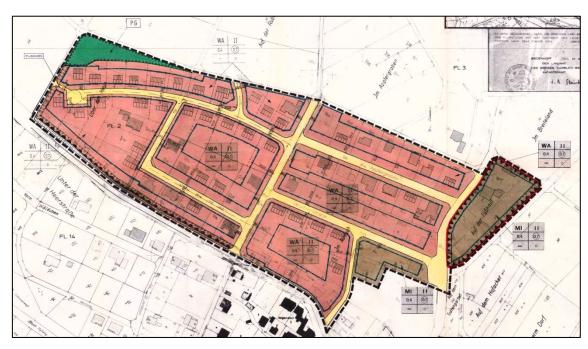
Benachbarter Bebauungsplan Nr. 1
